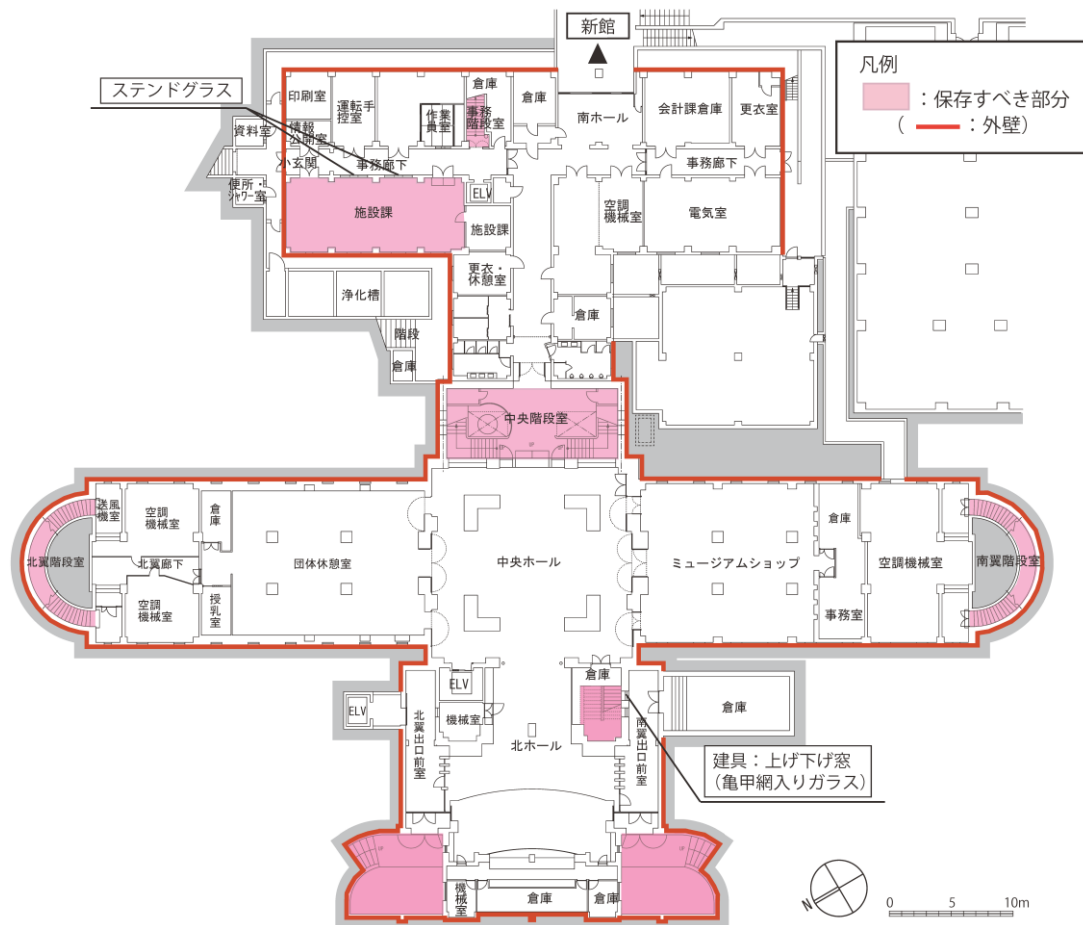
保存すべき部分 地下1階平面図（改修前地下1階平面図に加筆）
